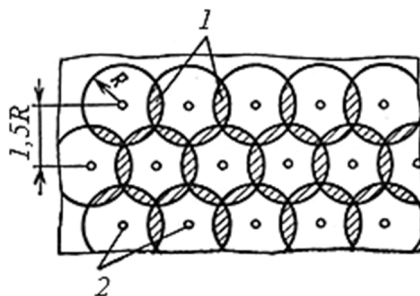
Схема перекриття зон ущільнення бетонної суміші: 1 – перекриття робочих зон глибинного вібратора; 2 – точка занурення вібратора в бетонну суміш
